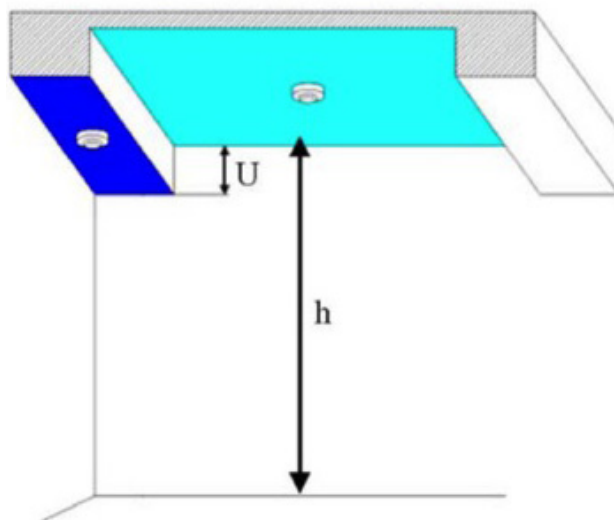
Altura del local y canto de la viga (UNE 23007-14:2014)
